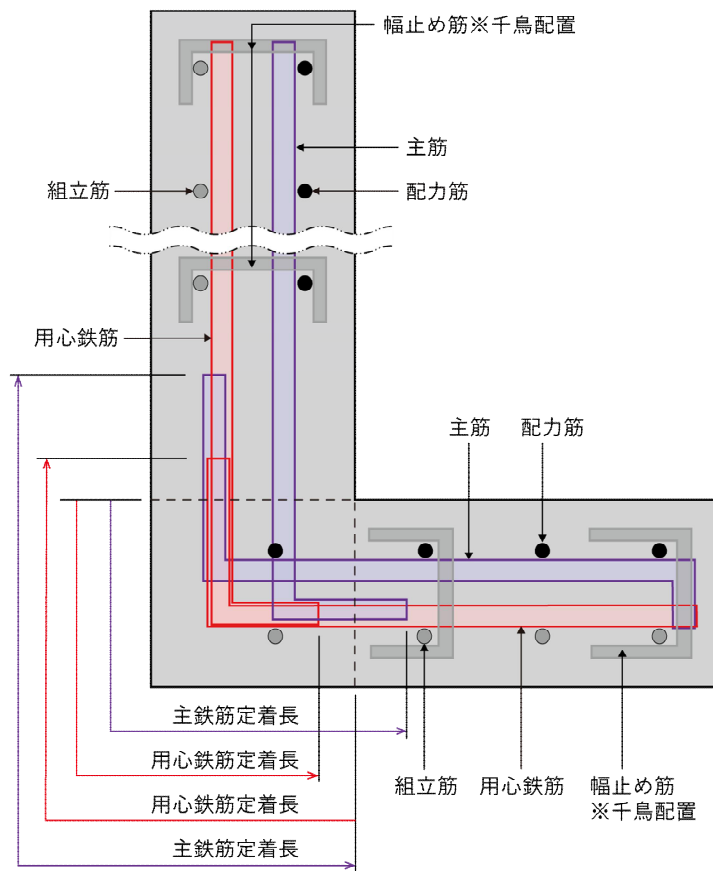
L型鉄筋コンクリート擁壁縦壁基部の配筋要領
